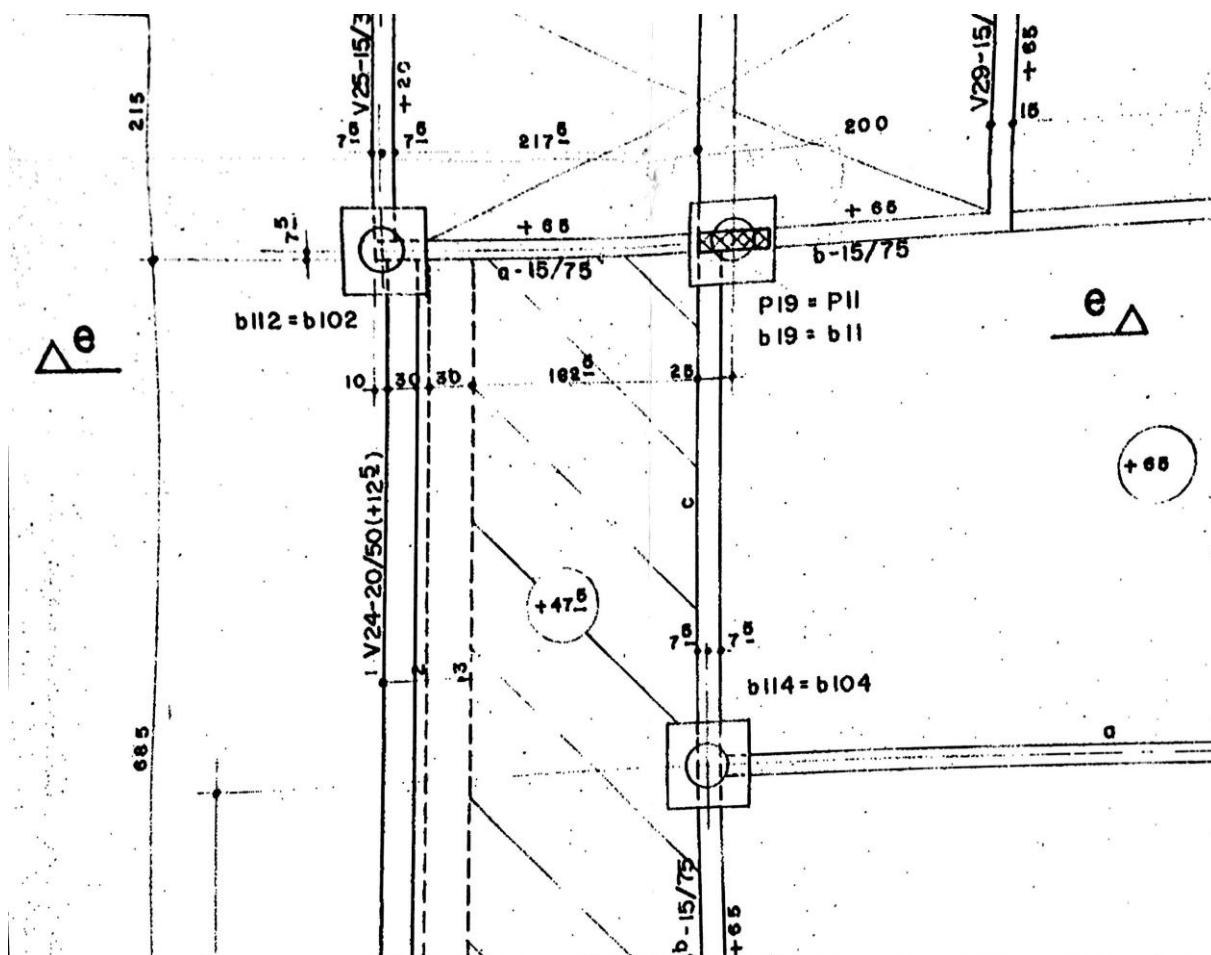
Planta das formas da Fundação - Edificação Principal – Região da Sala CPD
